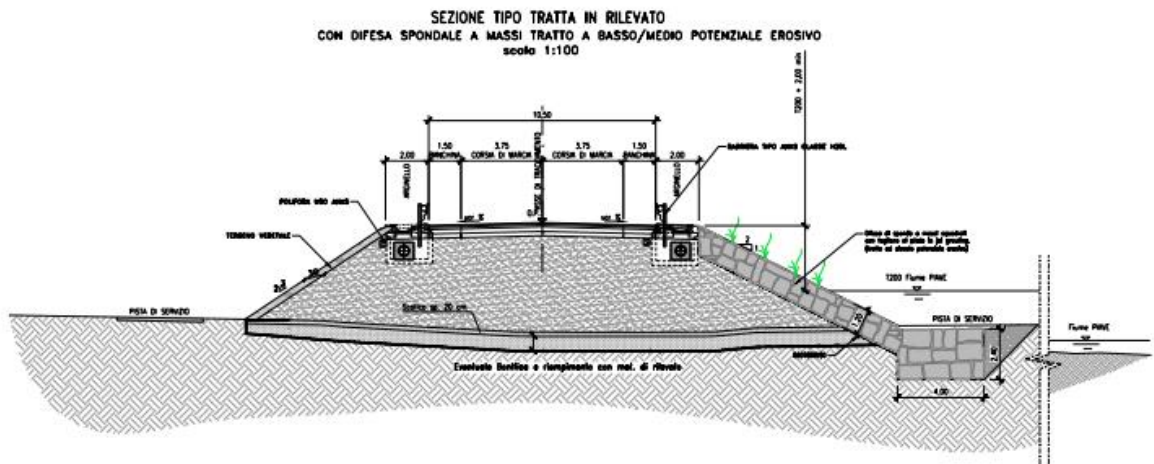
Sezione con protezione di sponda e piede con massi ciclopici.
